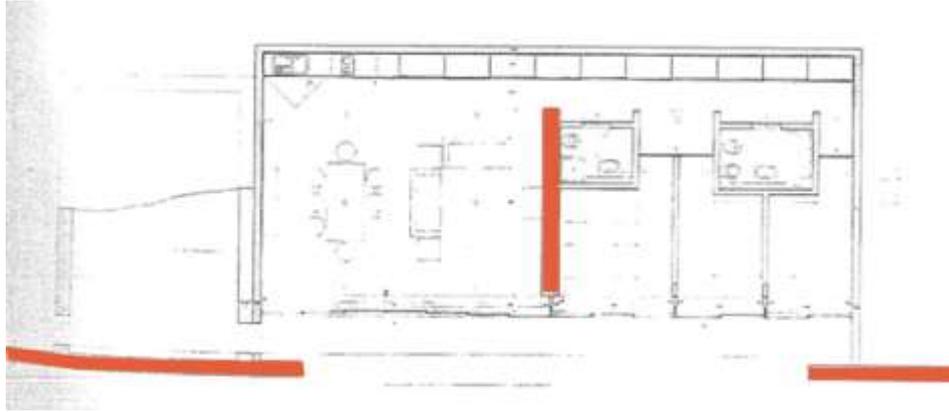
Planta da Casa de Baião demonstrando a colocação do muro exterior no interior como parede divisória
